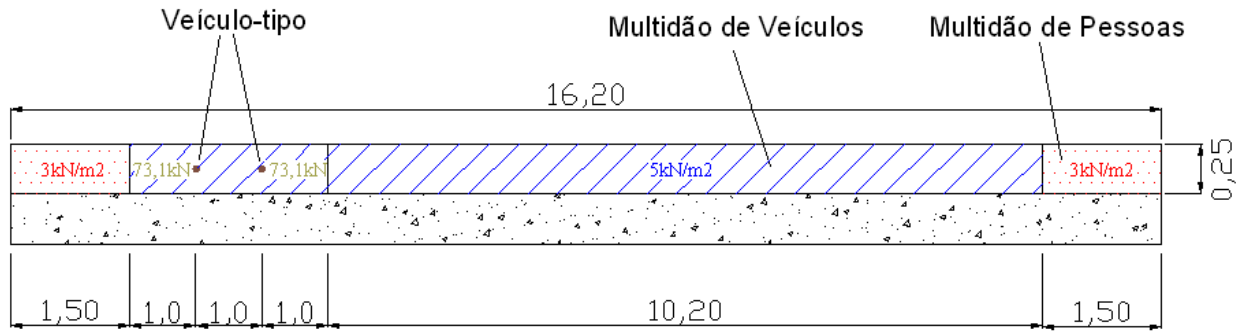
Carga móvel nos encontros (vista do encontro em planta e dimensões em m).
